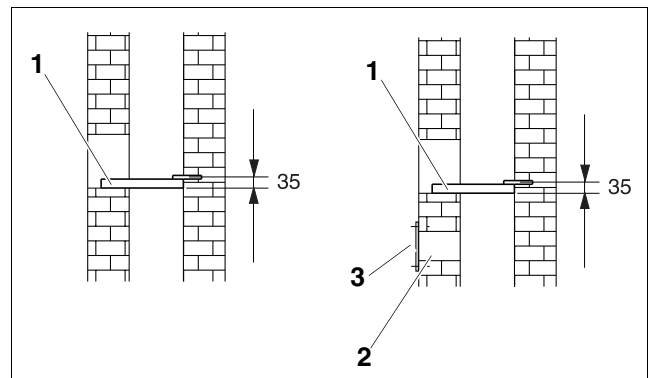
Auflageschiene montieren, rechts mit Hinterlüftung (Maße in mm)
